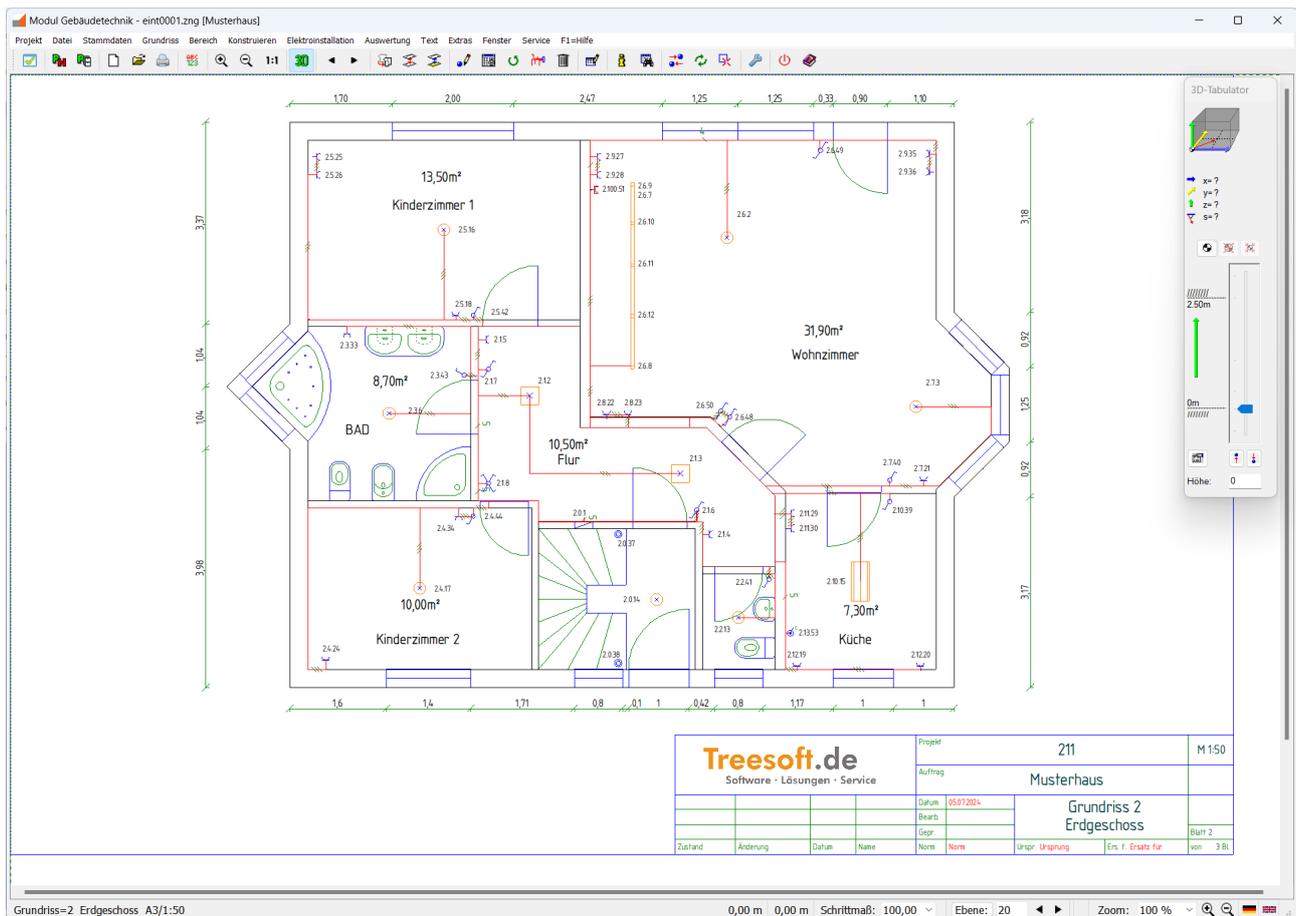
Manuell erstellter Grundrissplan
